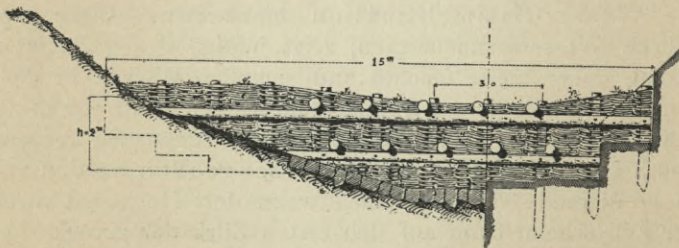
Holzsperrre, 2 m hoch. a Ansicht und Längenschnitt.
